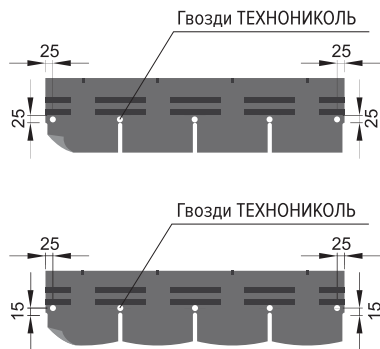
Схема крепления фасадной плитки на 5 гвоздей
